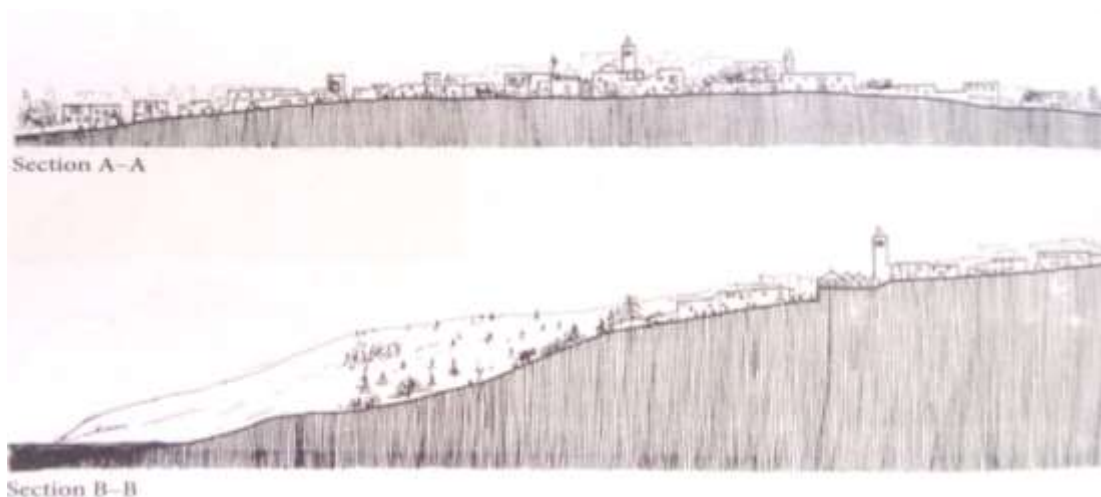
Sections de Sidi Bou Saïd mettent en valeur le niveau du village par rapport à celui de la mer. Les constructions adossées à la colline sont en élévation par rapport au niveau de la plage, à laquelle on accède par des longs escaliers à usage commun. Certaines propriétés implantées en premier rang disposent d'un accès privé à la plage (un escalier aménagé à l'extrémité du jardin).
